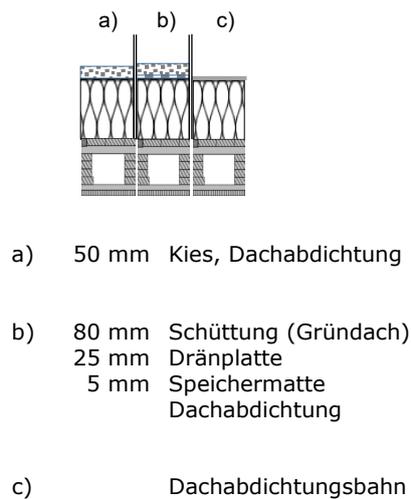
Vergleich der Aufbauten: Kiesdach, Gründach und einfache Dachabdichtungsbahn auf einem Brettsperrholz – Kastenelement mit 200 mm EPS Aufdachdämmung
